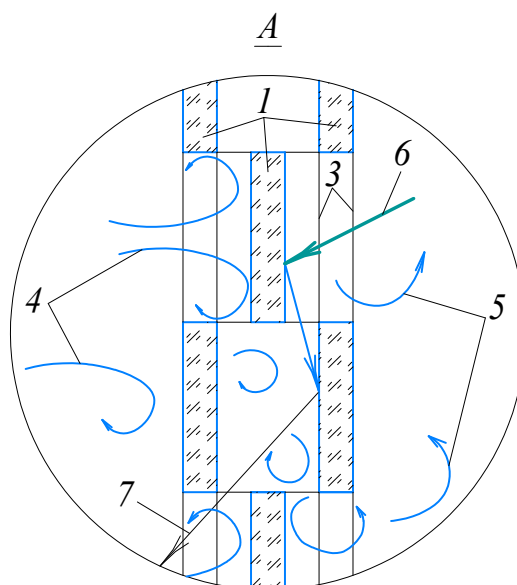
Звукопоглинальний комплекс (виноска А на рис. 3):
